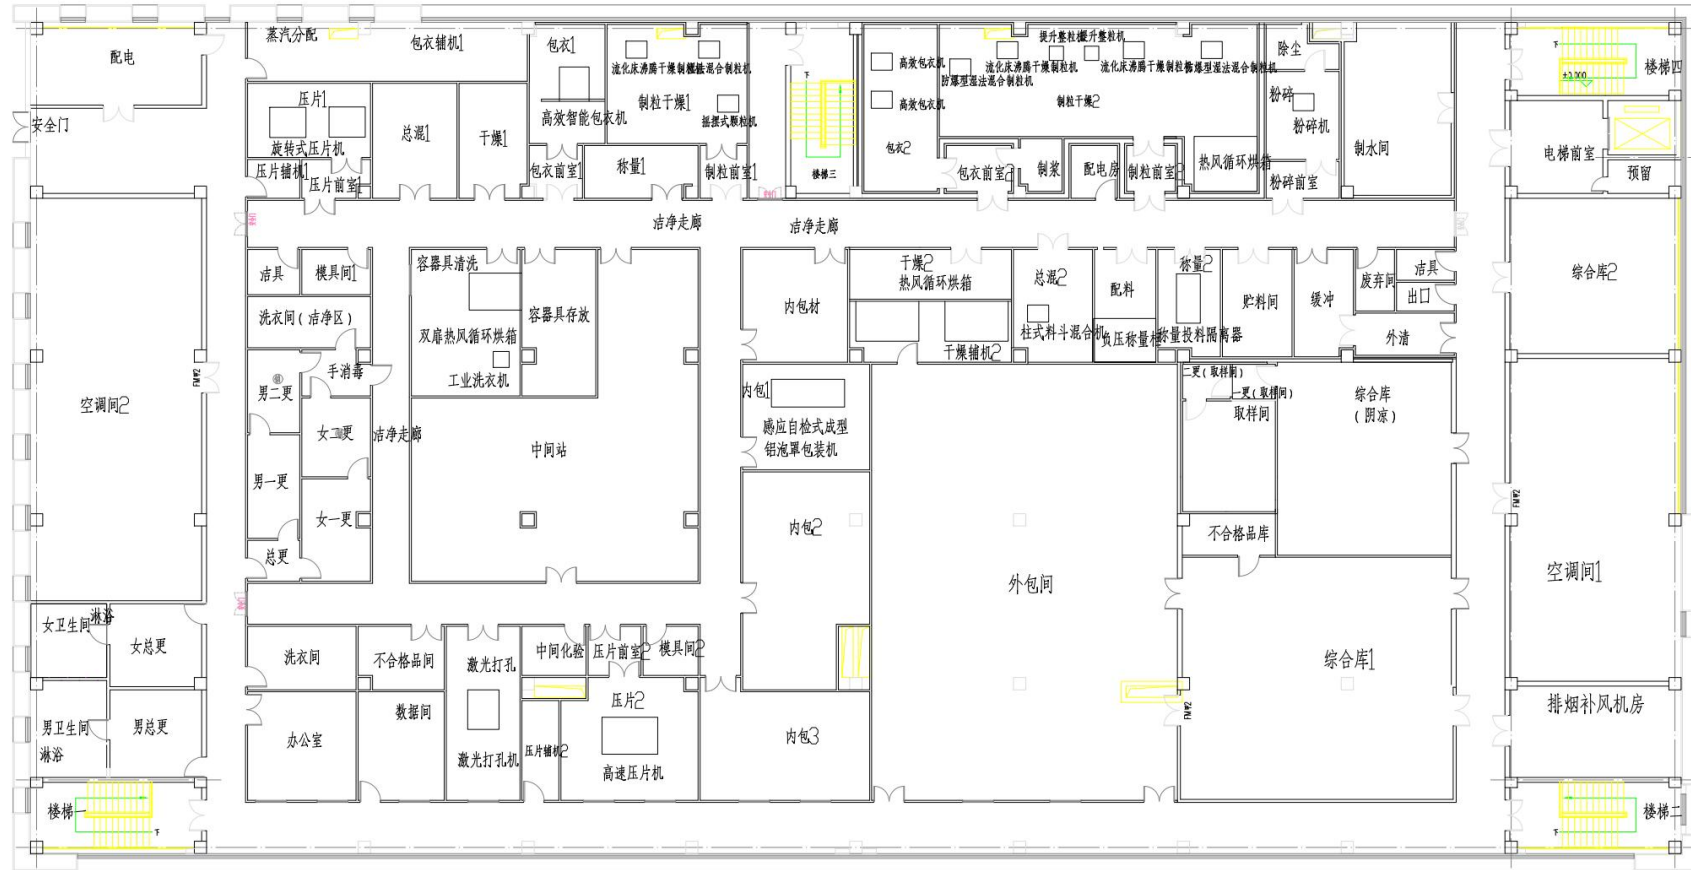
精麻车间平面图 (3F) 比例: 1:1000
